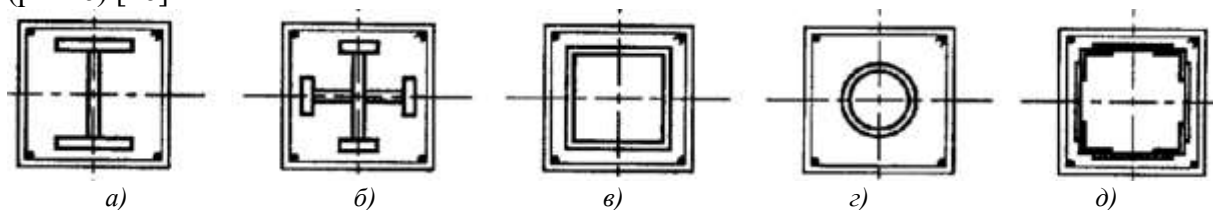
Типы поперечных сечений сталежелезобетонных колонн с жесткой арматурой из различных стальных профилей [16]
